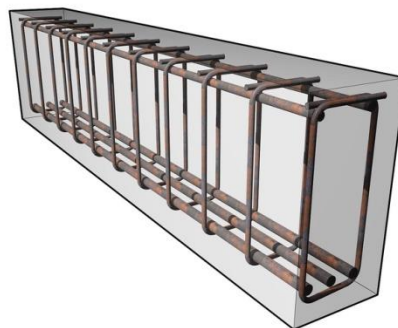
Esquema d'una biga de formigó armat amb l'armadura principal i els estreps
